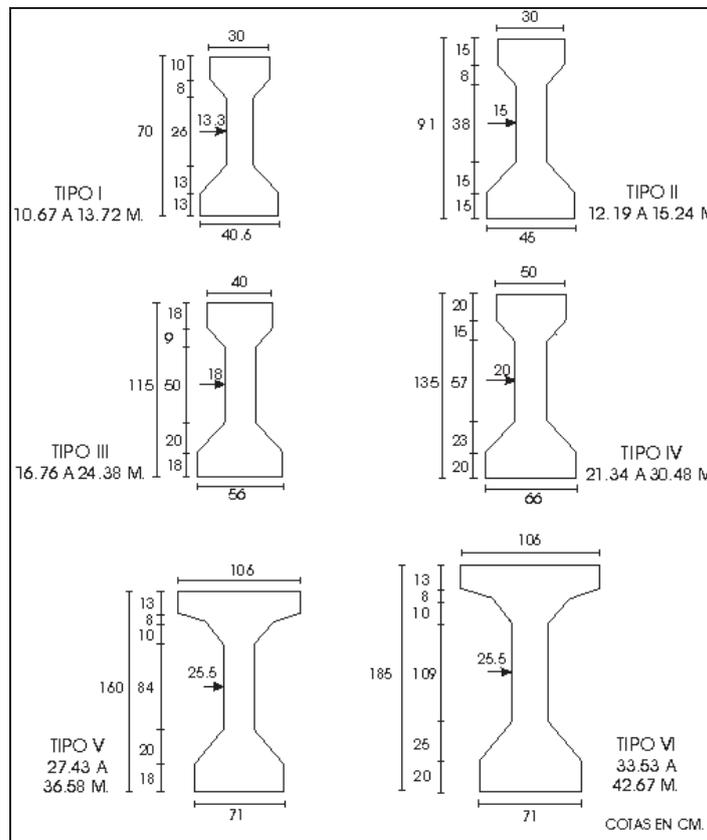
Secciones I de vigas AASHTO [14].
